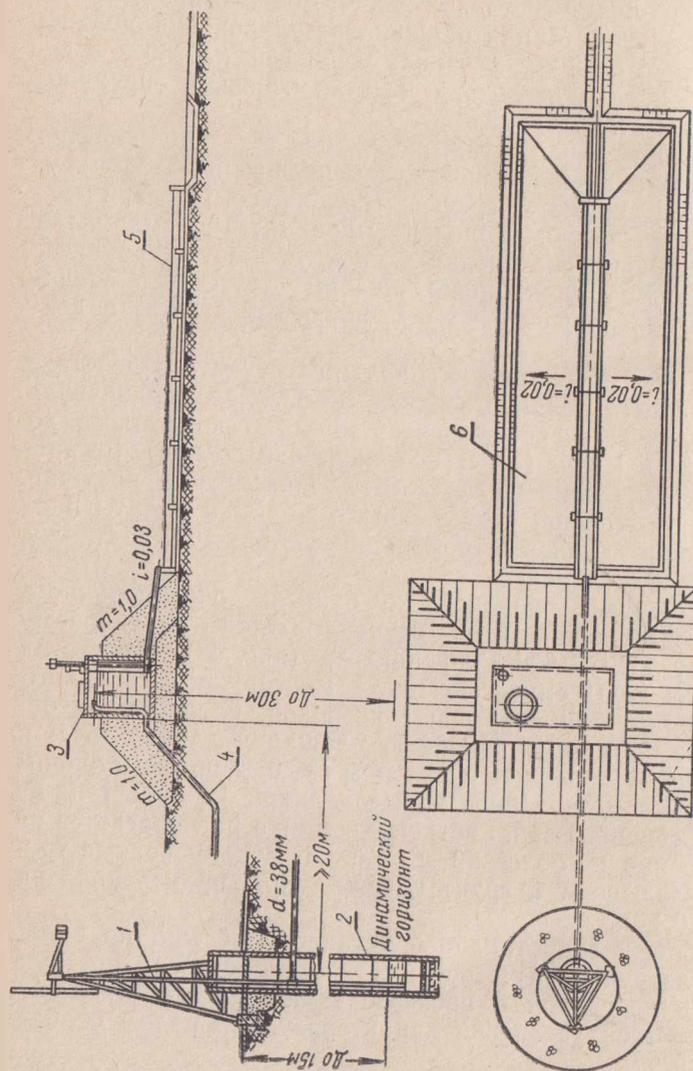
Вытяжной пункт, оборудованный ветродвигательной установкой ВВ-3:
